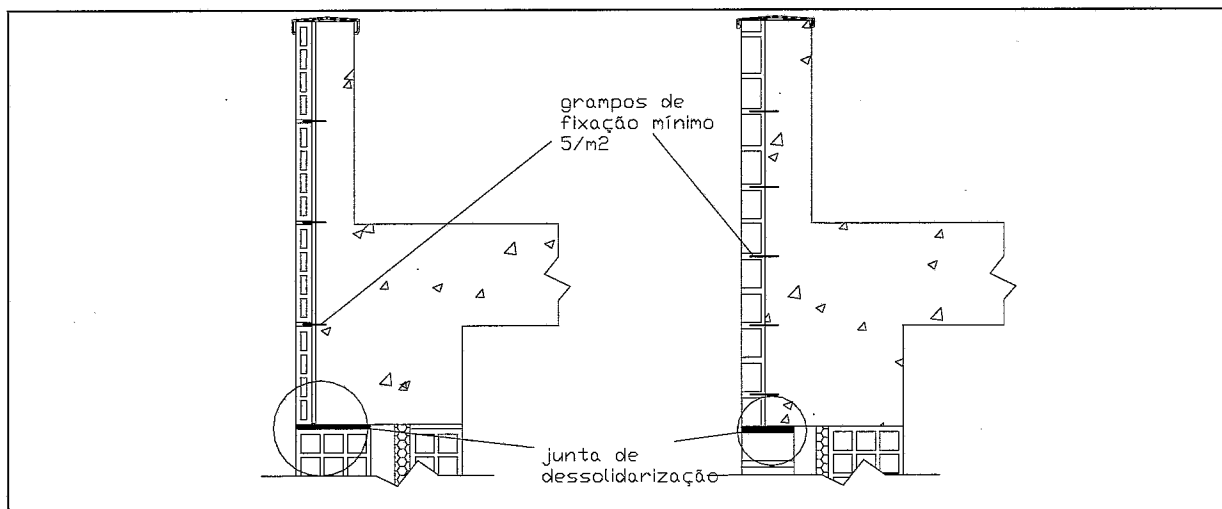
Pormenor de ligação entre laje de cobertura e parede exterior
